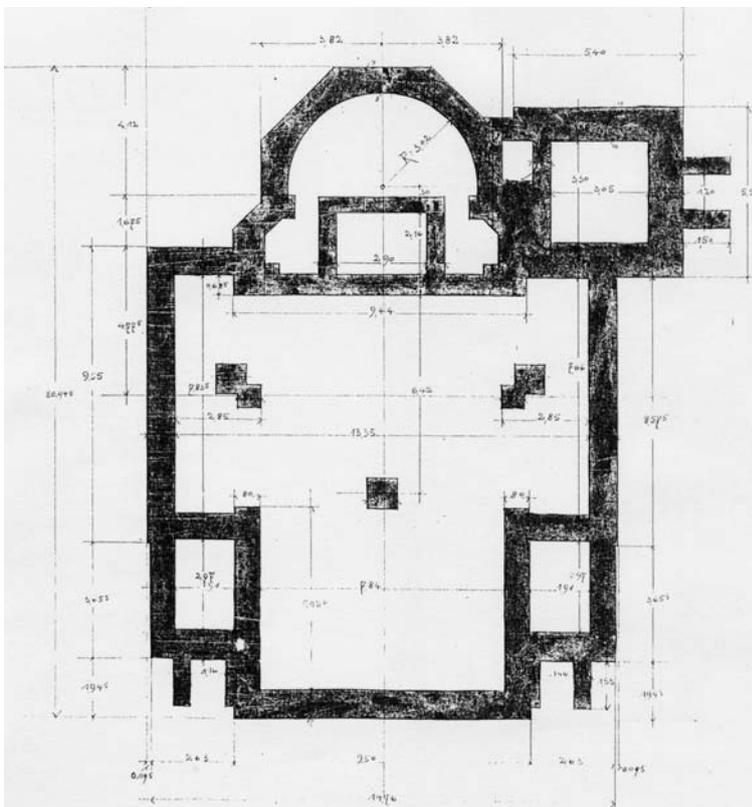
H. Plange, Grundriss der Fundamente, 1903
